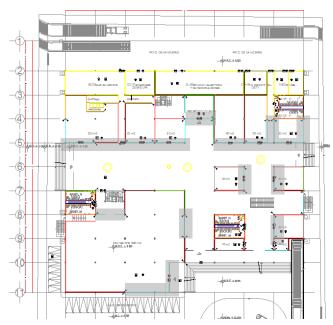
Ubicación en el plano de ventanales de piso a techo en Planta Baja
